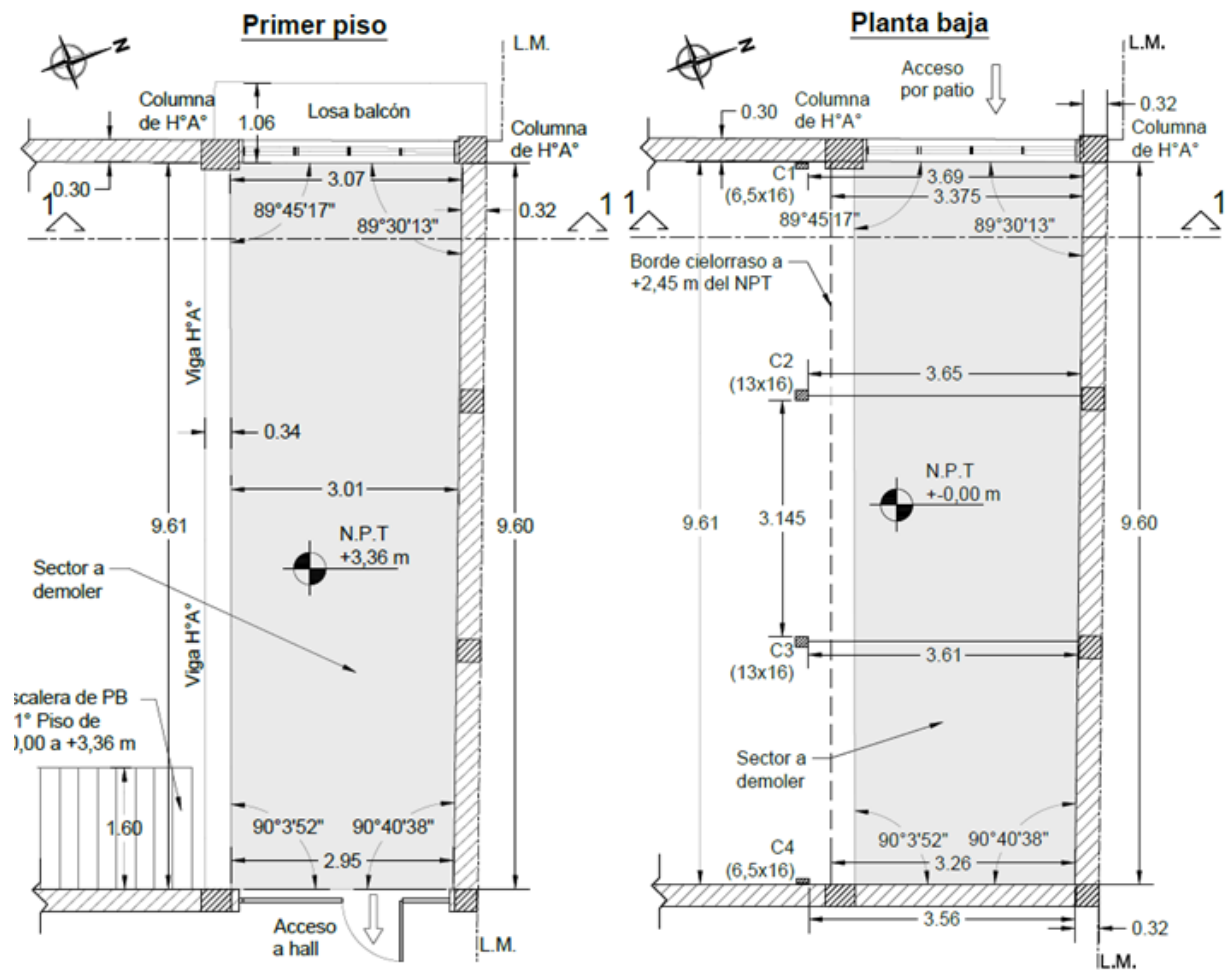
Relevamiento de planta baja y primer piso del sector a intervenir
